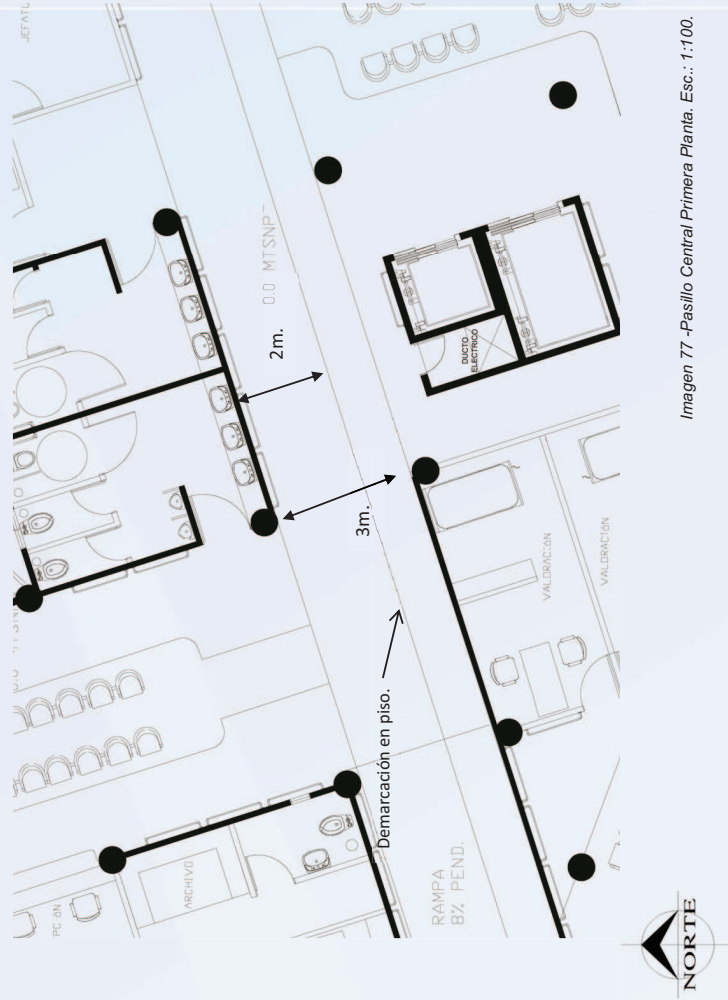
Pasillo Central Primera Planta. Esc.: 1:100.
